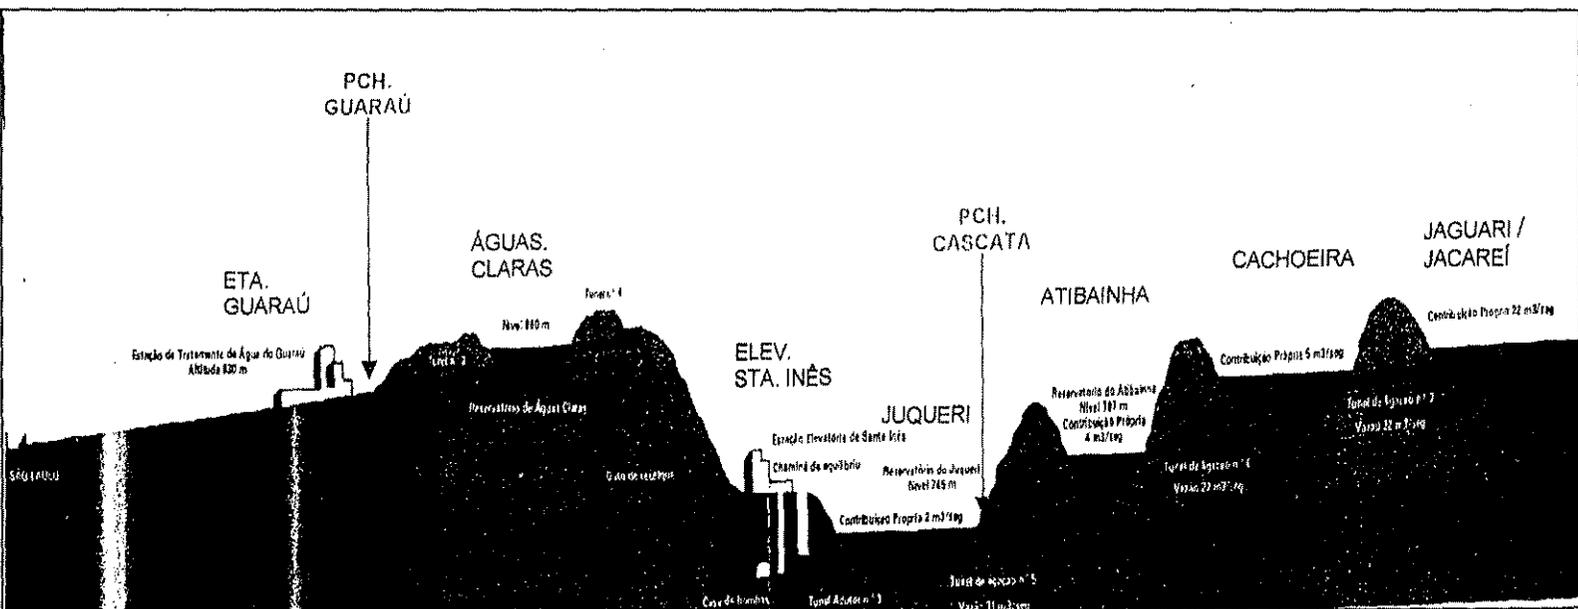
Sistema Cantareira – Perfil Hidráulico - (SABESP – 2004)
